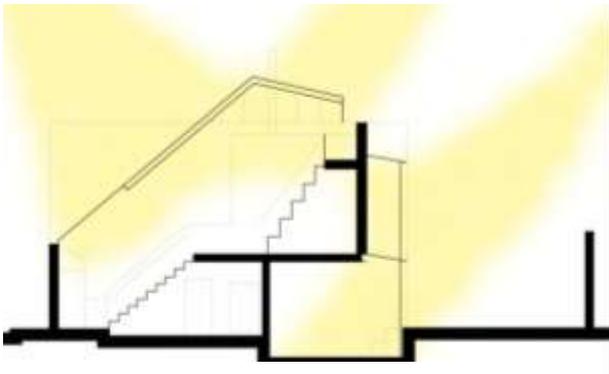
Sección con el soleamiento de la vivienda Murray Mews.
